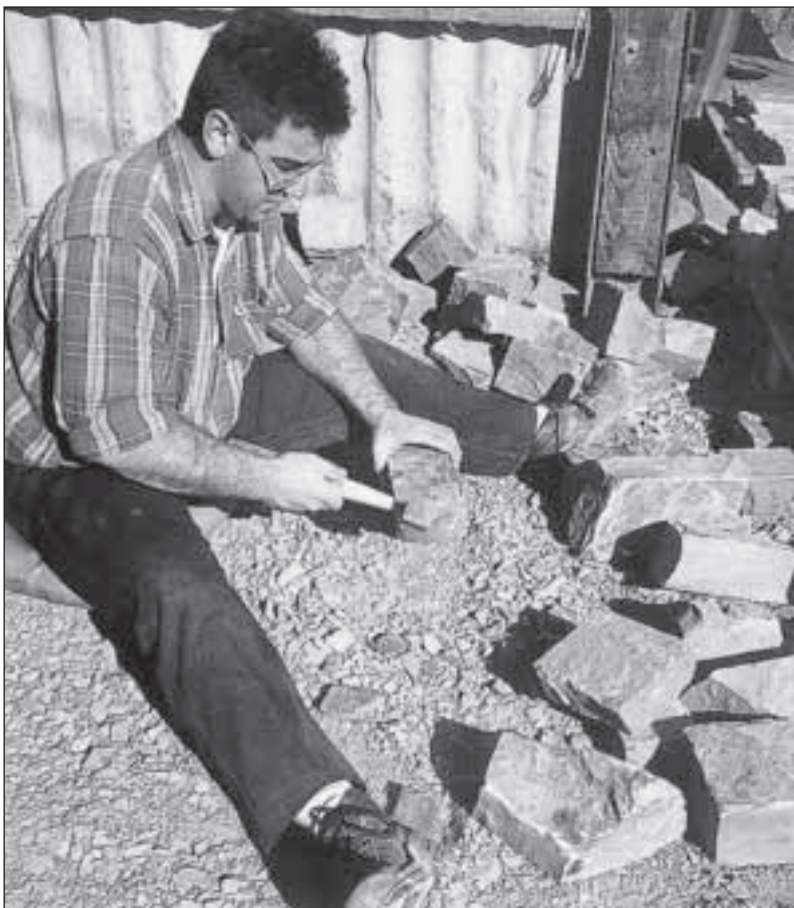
Grès du Condroz, retouche au petit marteau à Yvoir (Photo provenant de l'ouvrage sous rubrique).
